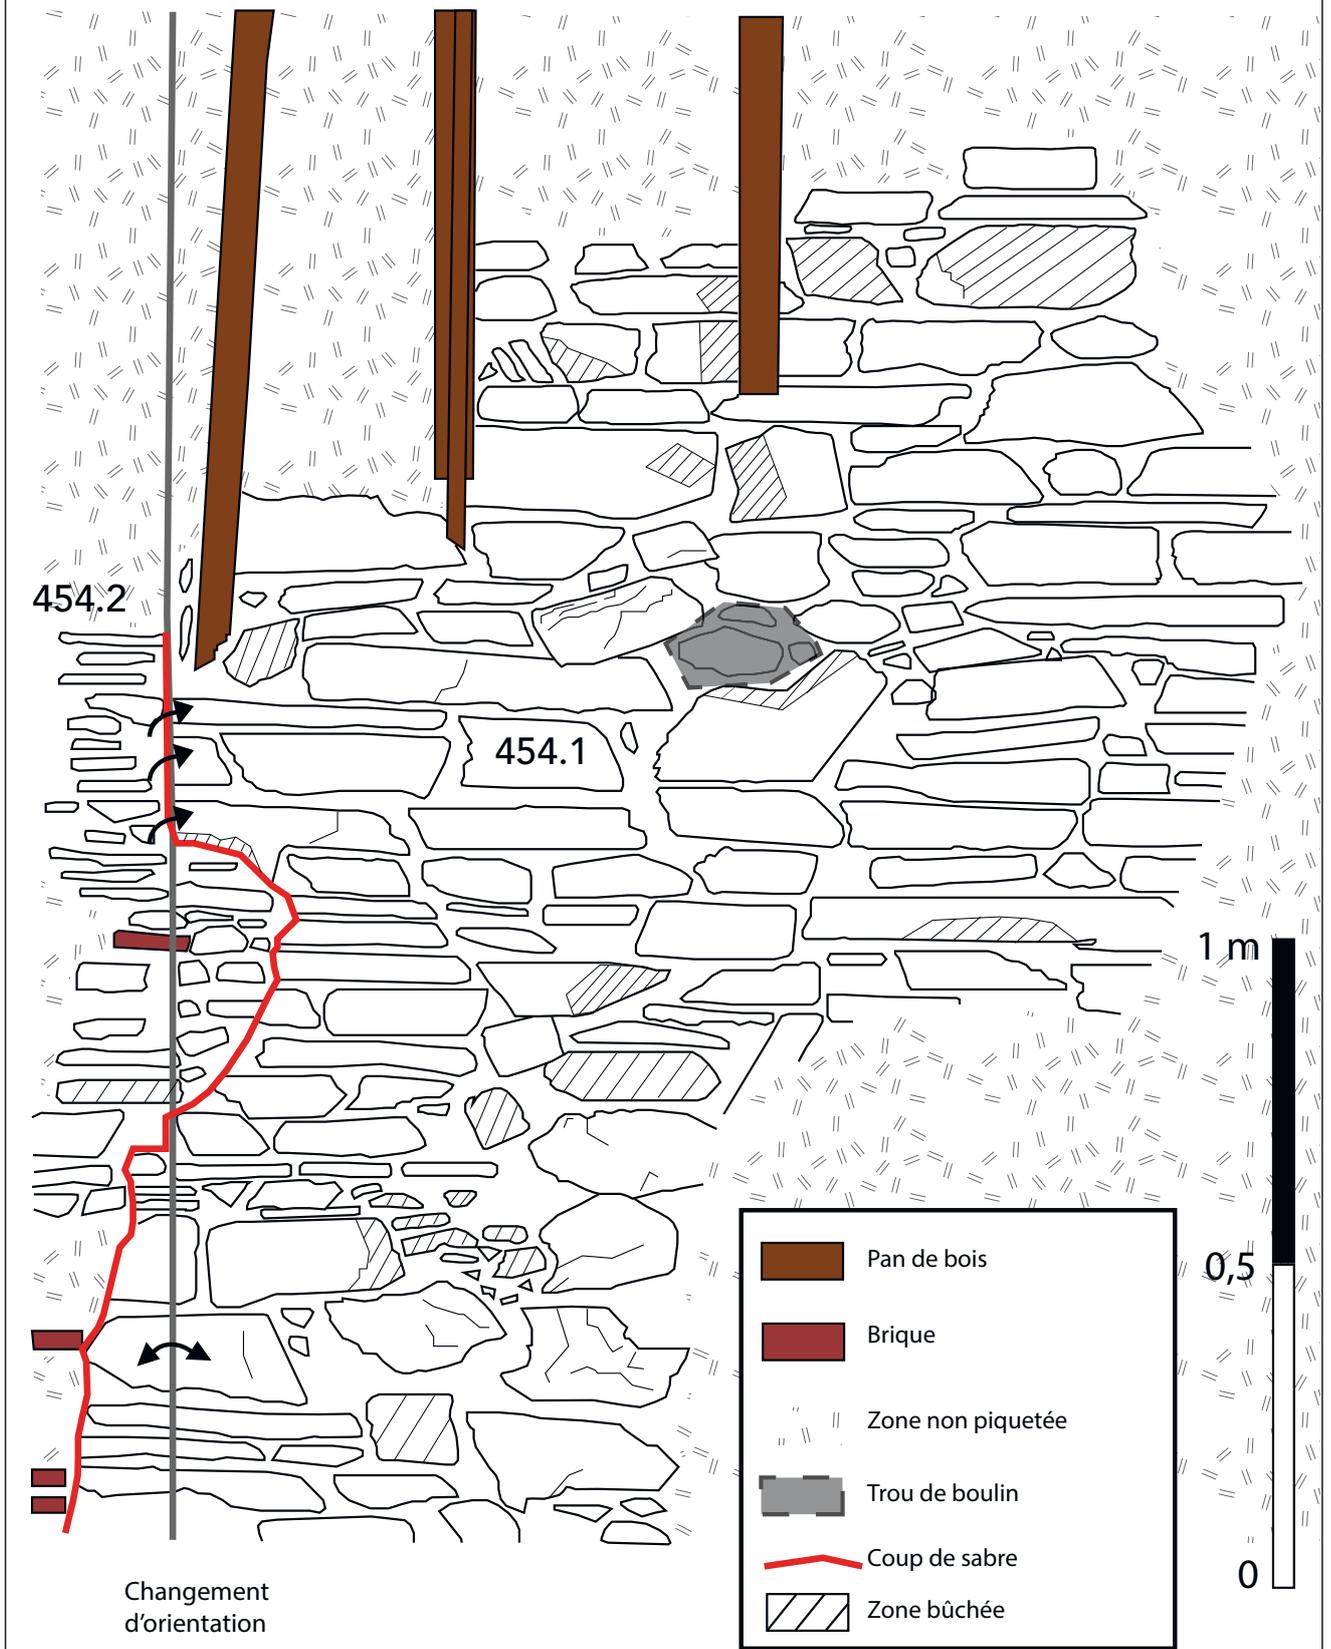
Relevé pierre à pierre du parement externe du boulevard de la porte aux Foulons au RDC du n°8
